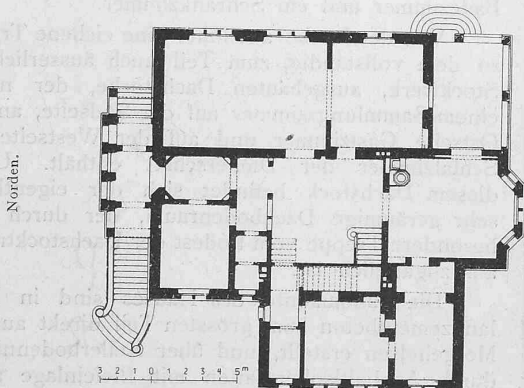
Grundriss vom Erdgeschoss. — Masstab 1 : 400.
